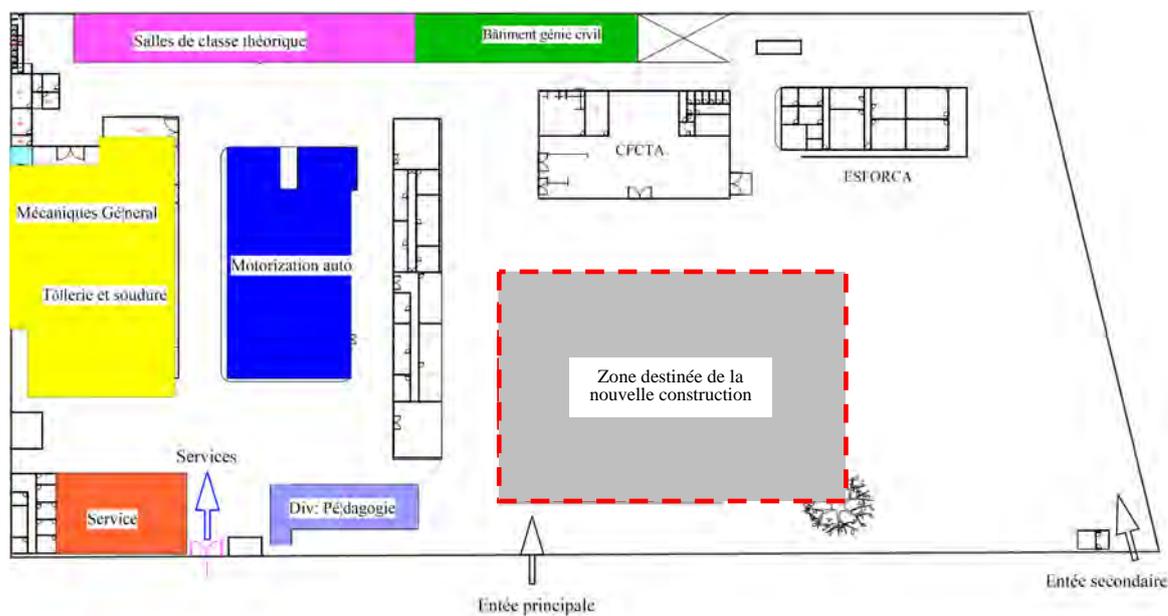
Plan de réimplantation des fonctions du site de la Diprokin
